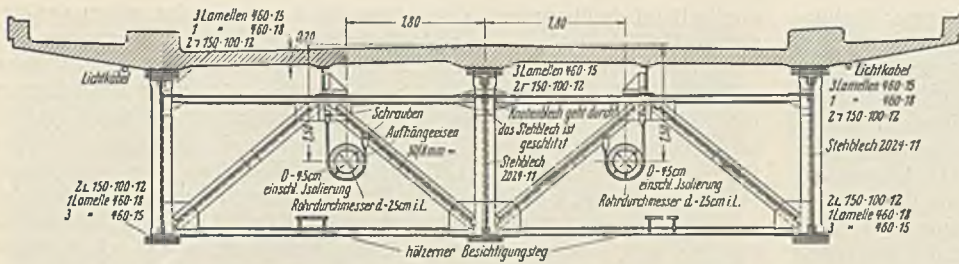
Querschnitt des Einhängeträgers über der Schifffahrtöffnung.
